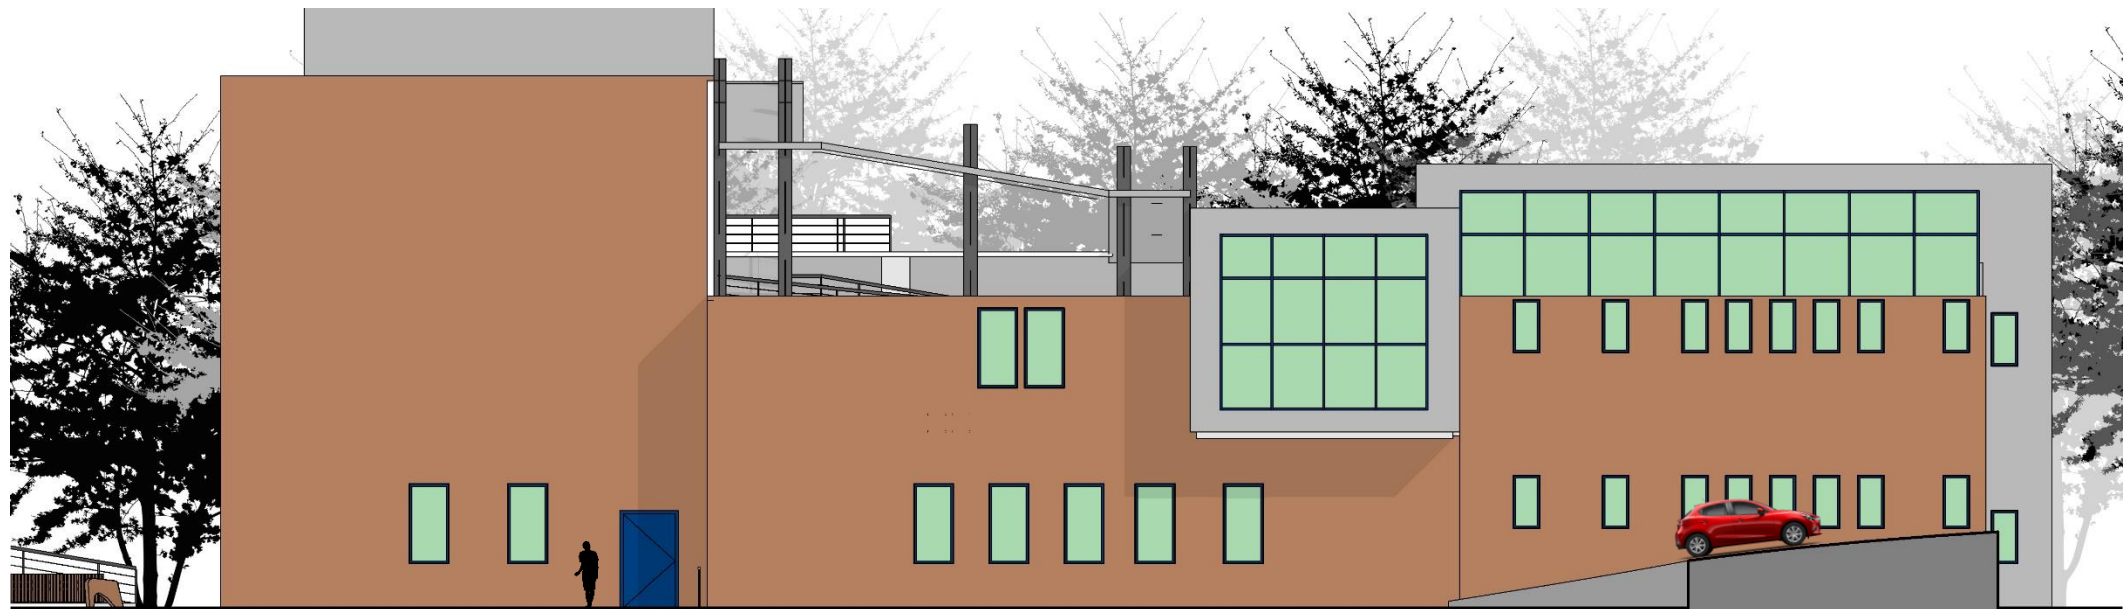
Elevación Nor-Este. Fuente: Elaboración propia.
